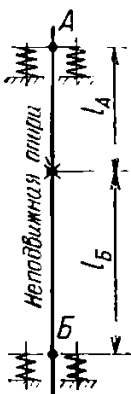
Схема вертикальных перемещений для пружинных опор трубопроводных стояков
